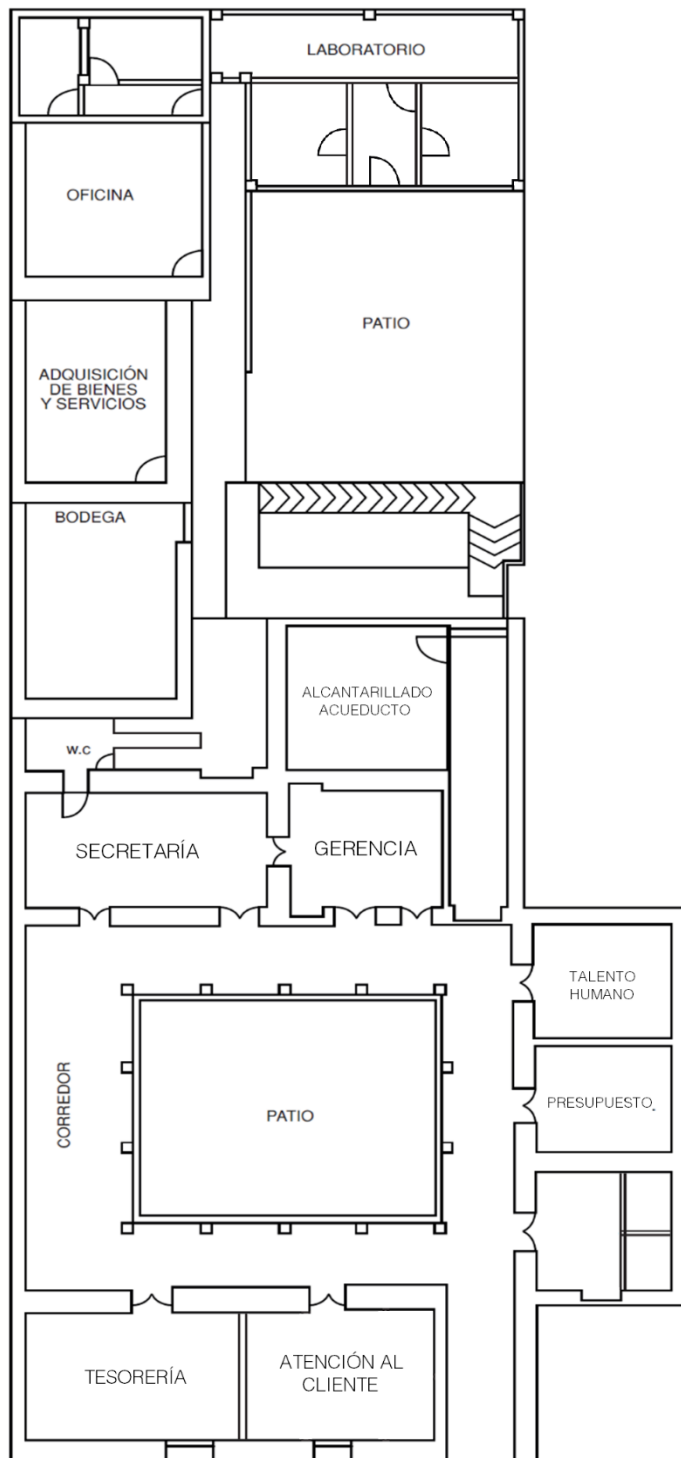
Planos de reubicación de las oficinas (Planta baja)
